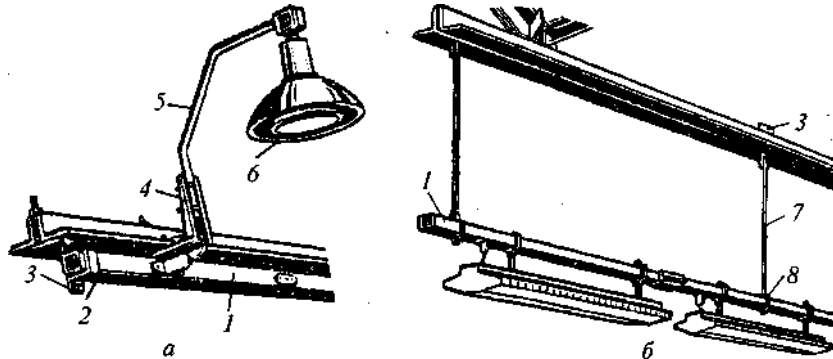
Кріплення шинопроводу вздовж металевих ферм
